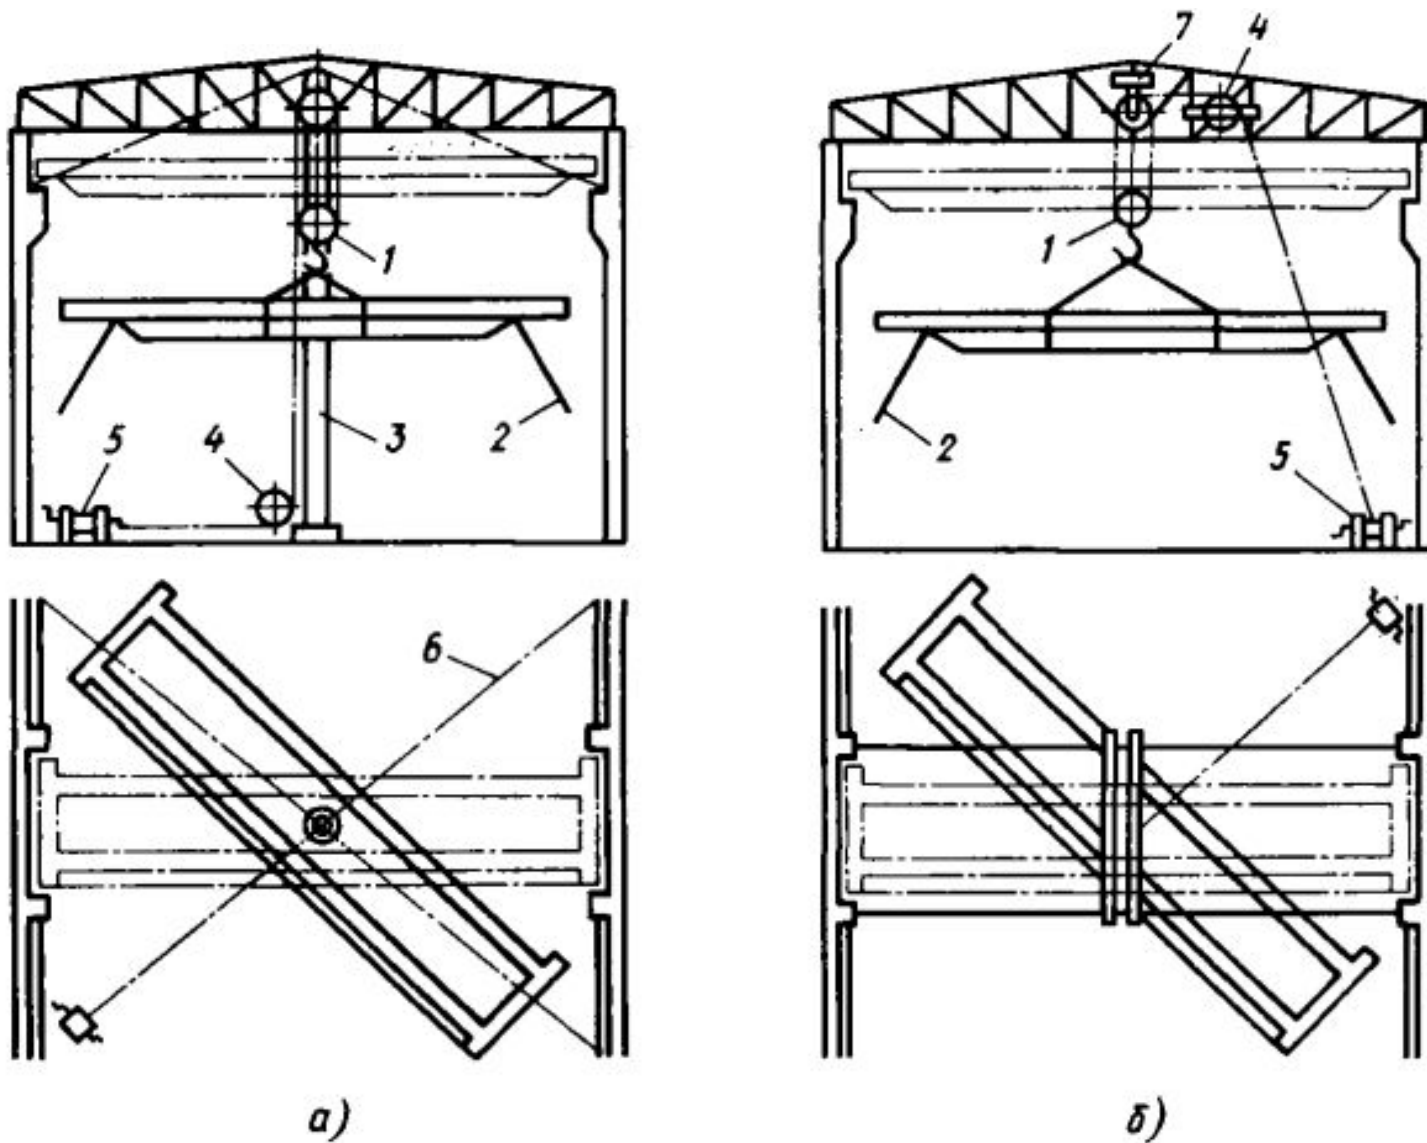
Схема подъема моста с последующим разворотом над крановыми путями: а – монтажной мачтой, б – монтажной балкой: 1 – полиспаст, 2 – оттяжка, 3 – мачта, 4 – отводной блок, 5 – монтажная лебедка, 6 – расчалка, 7 – подвеска монтажного полиспаста
